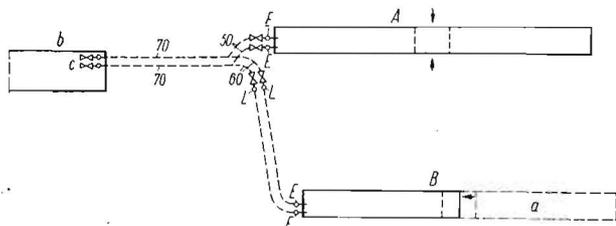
Lageplan der Kükenaufzuchtanlage in der LPG Bahragrund in Behrungen; A und B Kükenställe aus je 2 Stalleinheiten, die Errichtung der zweiten Stalleinheit a des Gebäudes B ist für die Perspektive vorgesehen, b Technik-Gebäude, c Heizkessel; E Entleerung, L Lüftung
